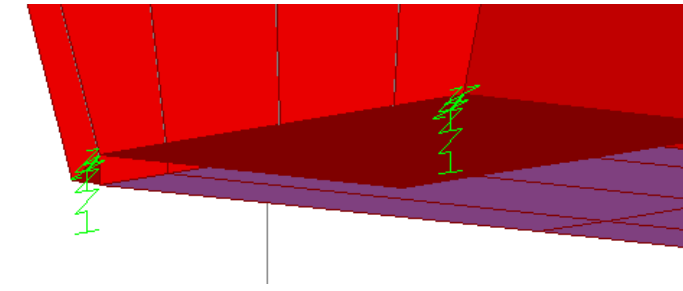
Detalle modelización apoyos. CSiBridge 16
